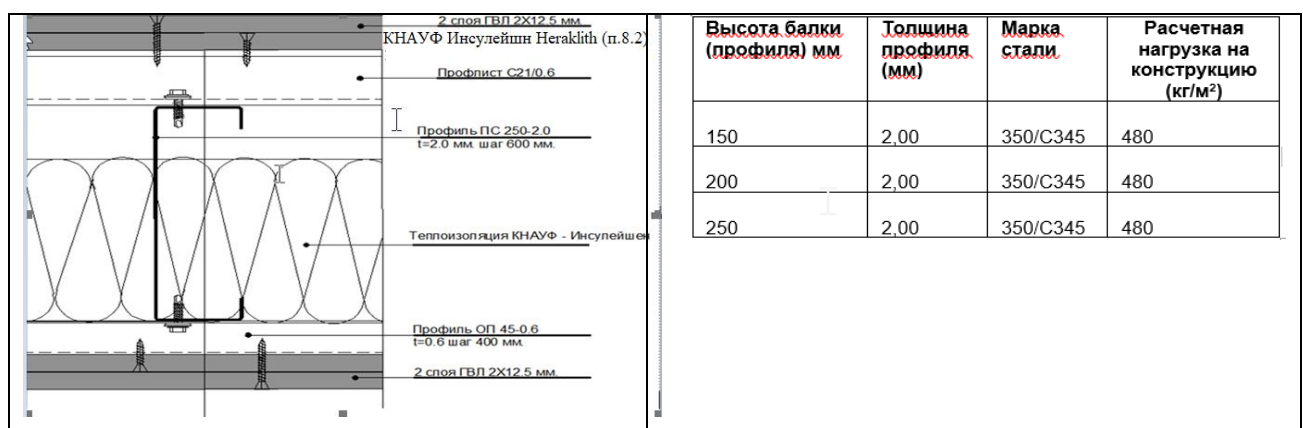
Эскиз межэтажного перекрытия III степени огнестойкости
